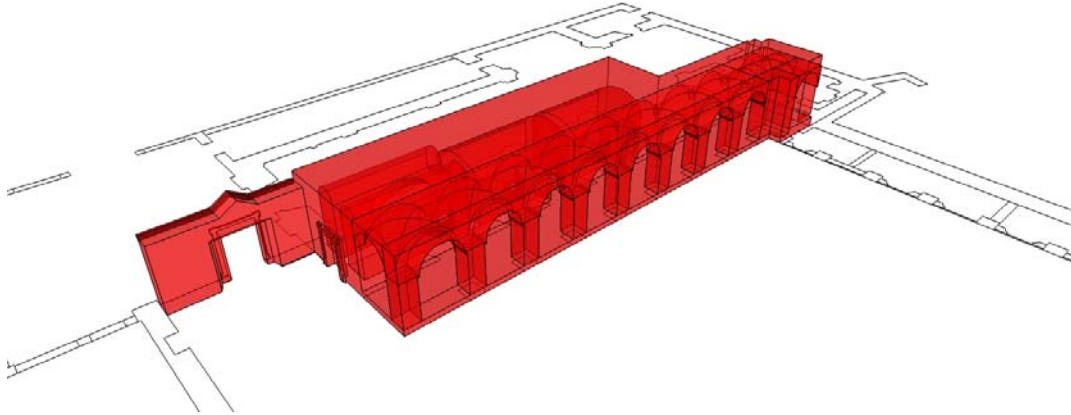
Reconstrucción Virtual Sector 1a: Ala Sur Planta Baja.
